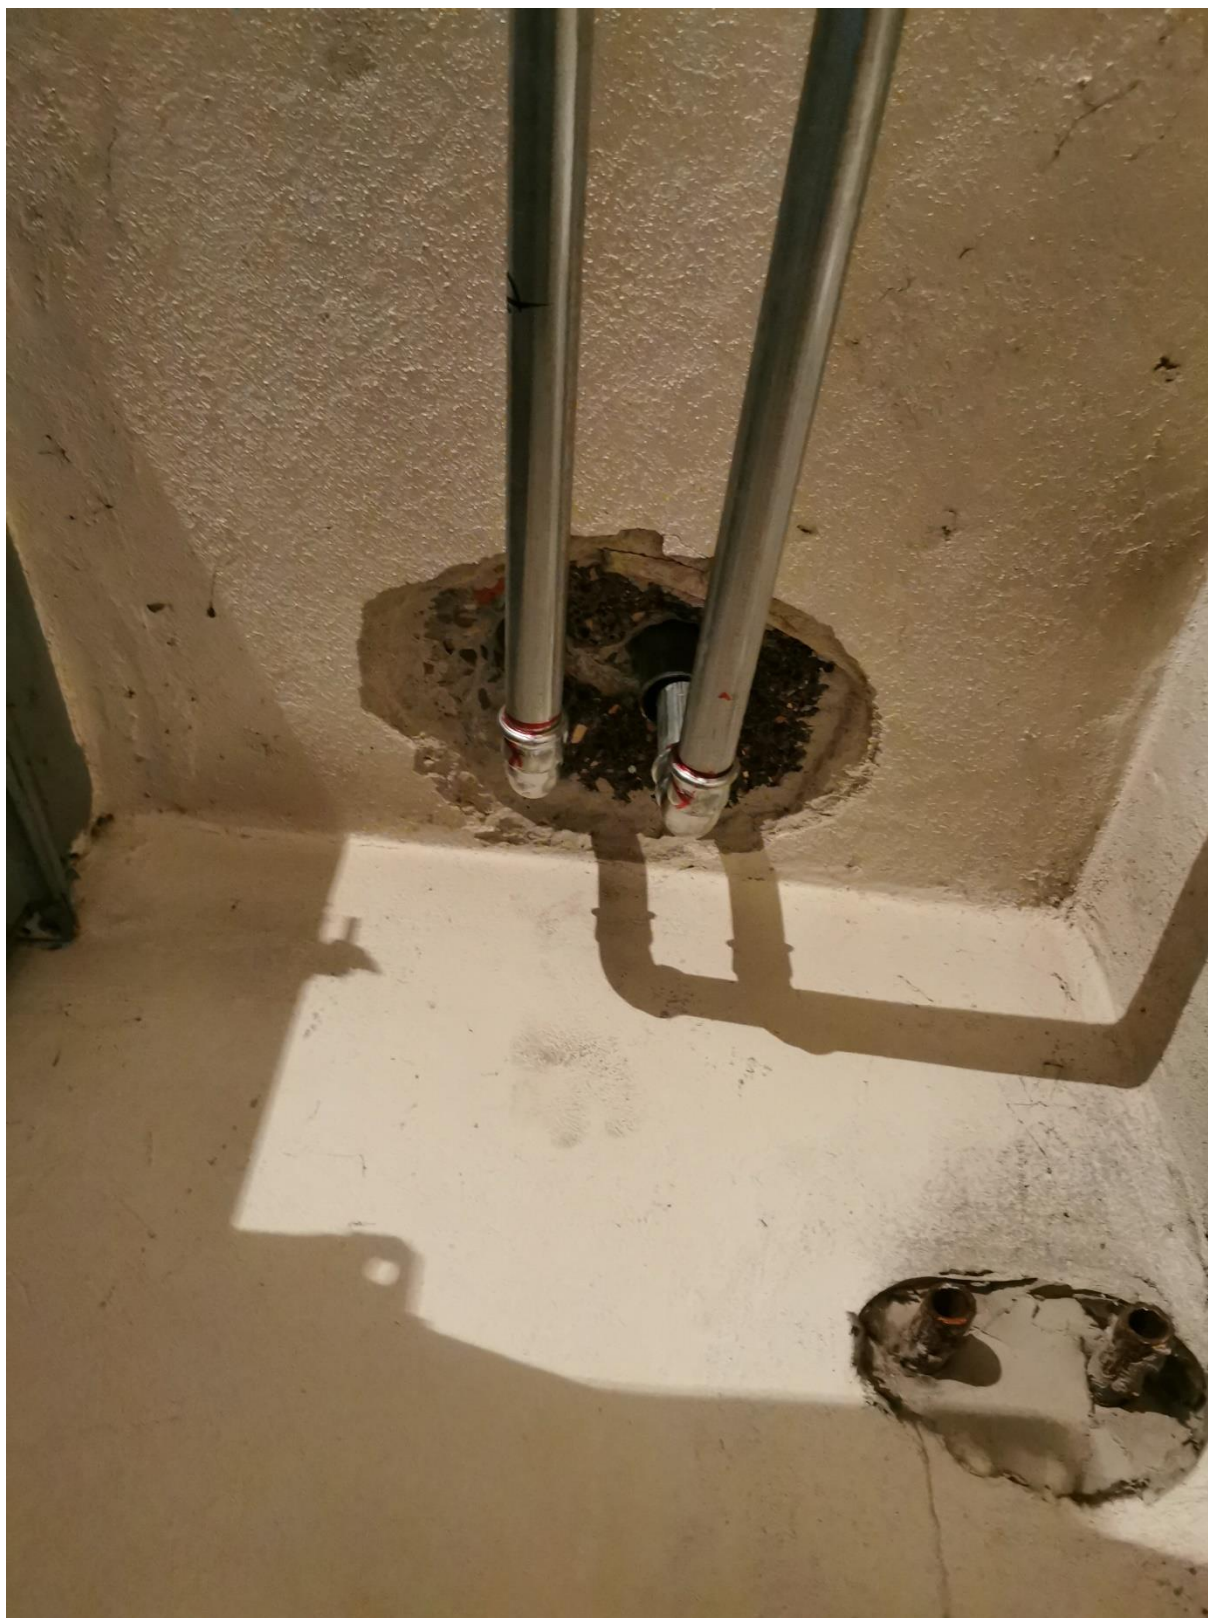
2.18C – brak odtworzenia do stanu pierwotnego przejścia instalacji przez przegrody, brak rur ochronnych, brak odtworzenia po demontażach, styk instalacji z infrastrukturą
